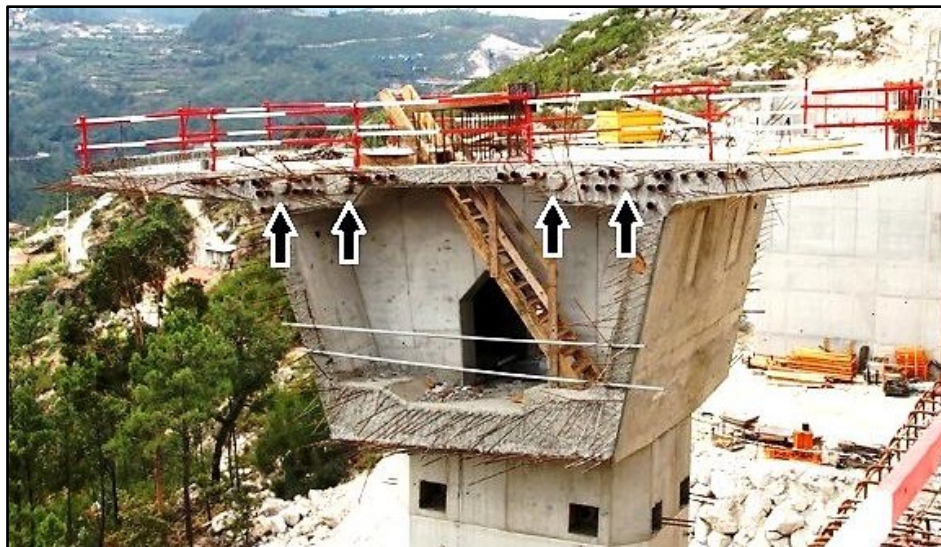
Vista da junta de betonagem da primeira aduela e respectivas ancoragens e bainhas de pré-esforço
